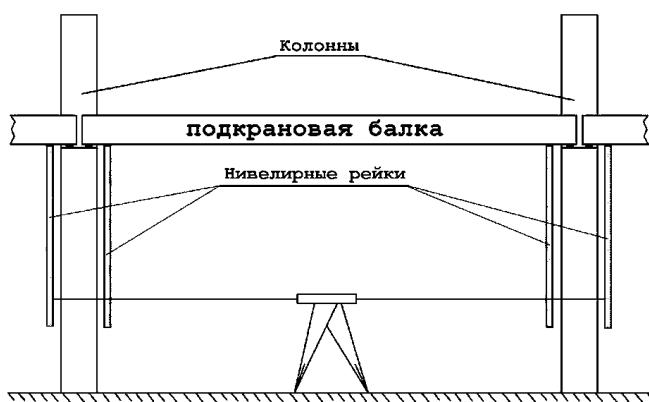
Исполнительная съемка опирания подкрановых балок методом геометрического нивелирования
